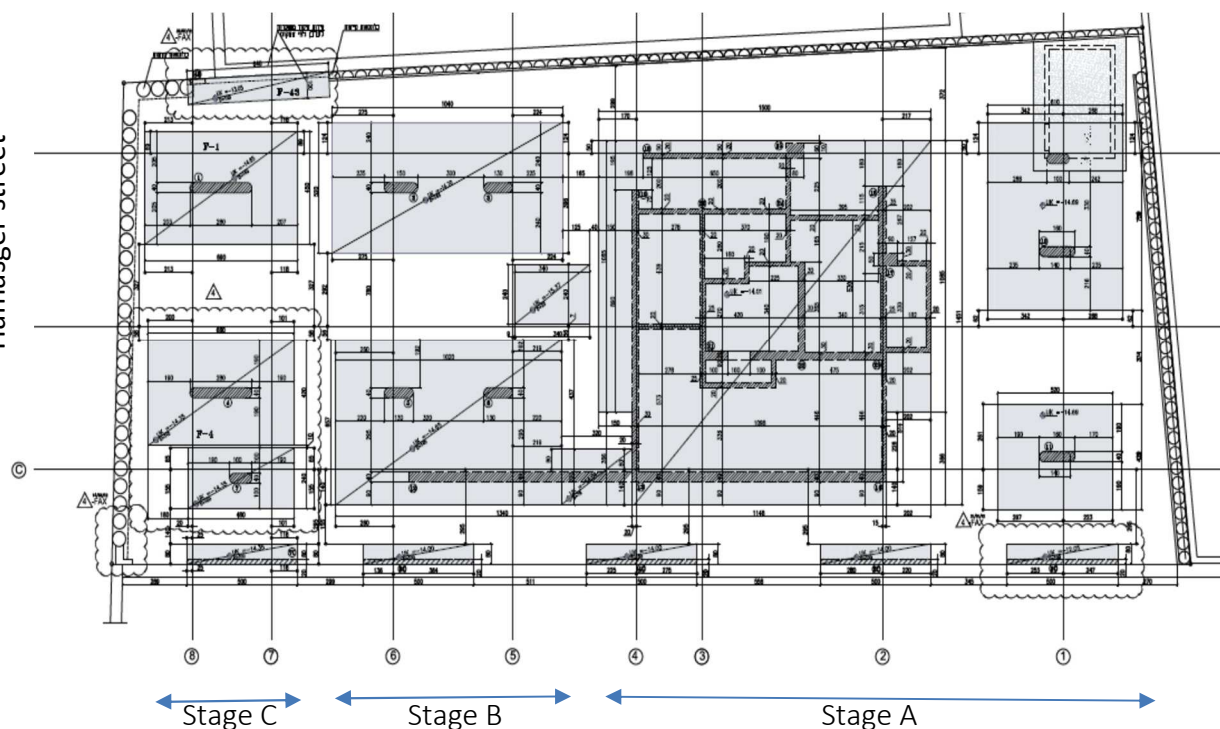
План фундаментов здания. Отметка подошвы –14.70 м
